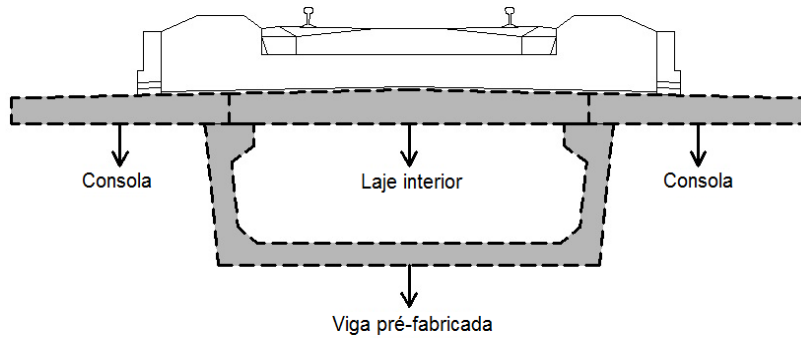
Secção transversal destacando os respectivos elementos estruturais
